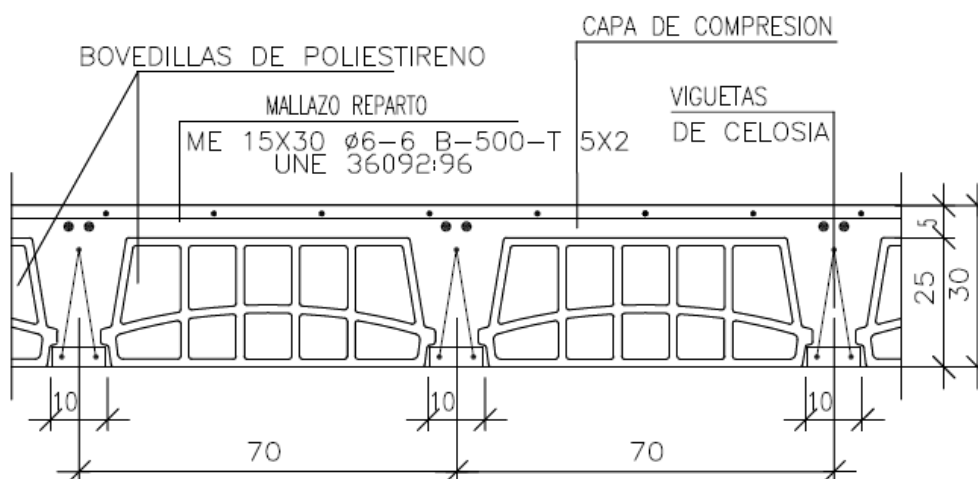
Detalle de sección del forjado entre plantas con AutoCAD.
